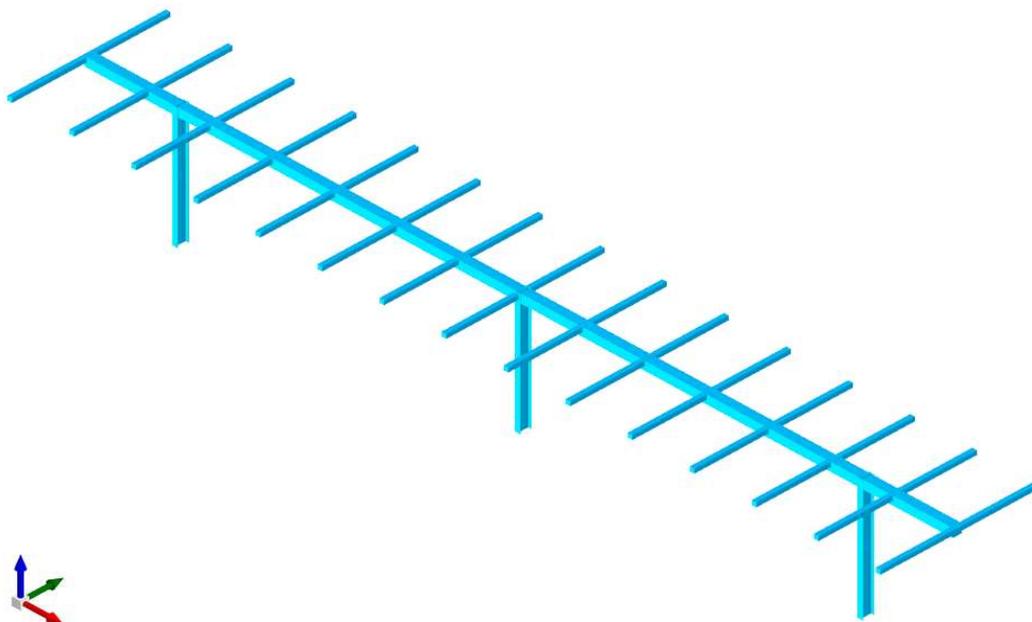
Vista assonometrica modello strutturale con posizione della “vela” orizzontale
